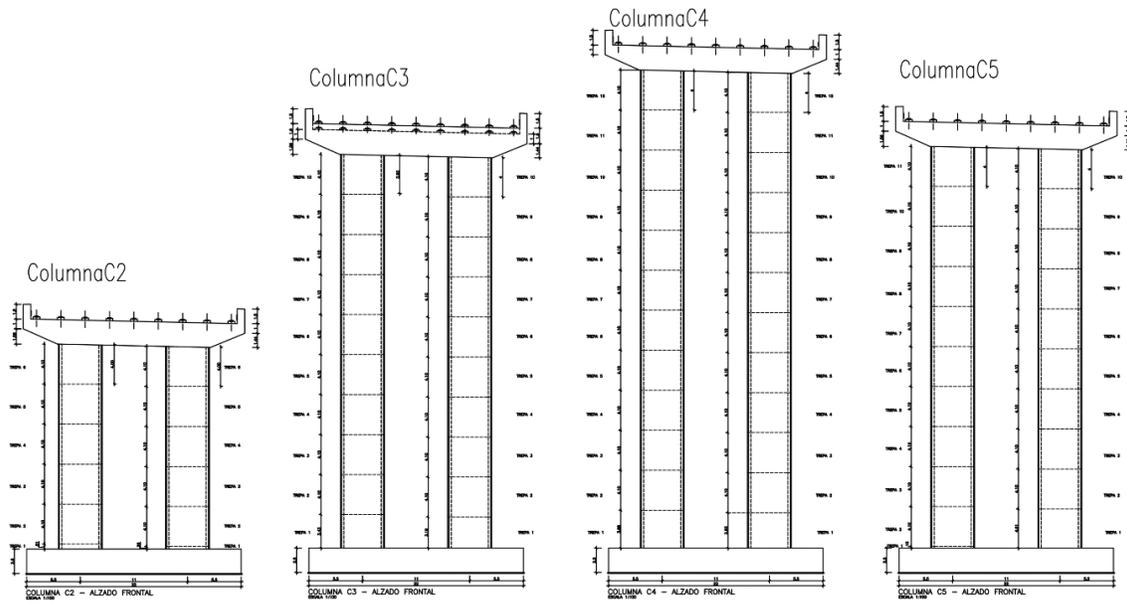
Sistema de cimbra modulada para el viaducto 20+880.
